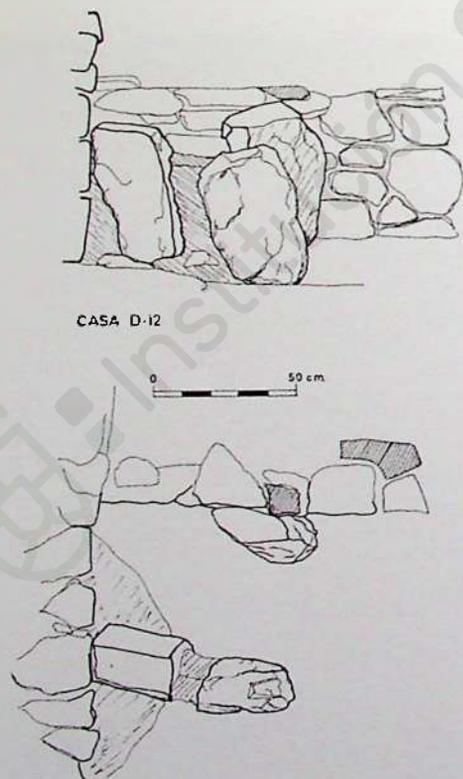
Estructura de piedras de la casa D12. Planta y vista lateral.
